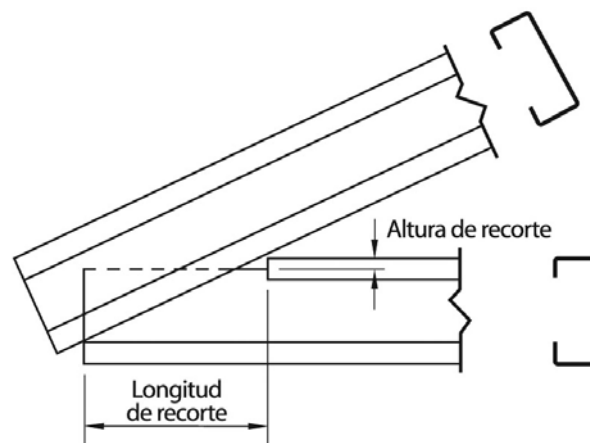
Definición de dimensiones de recorte en cerchas
